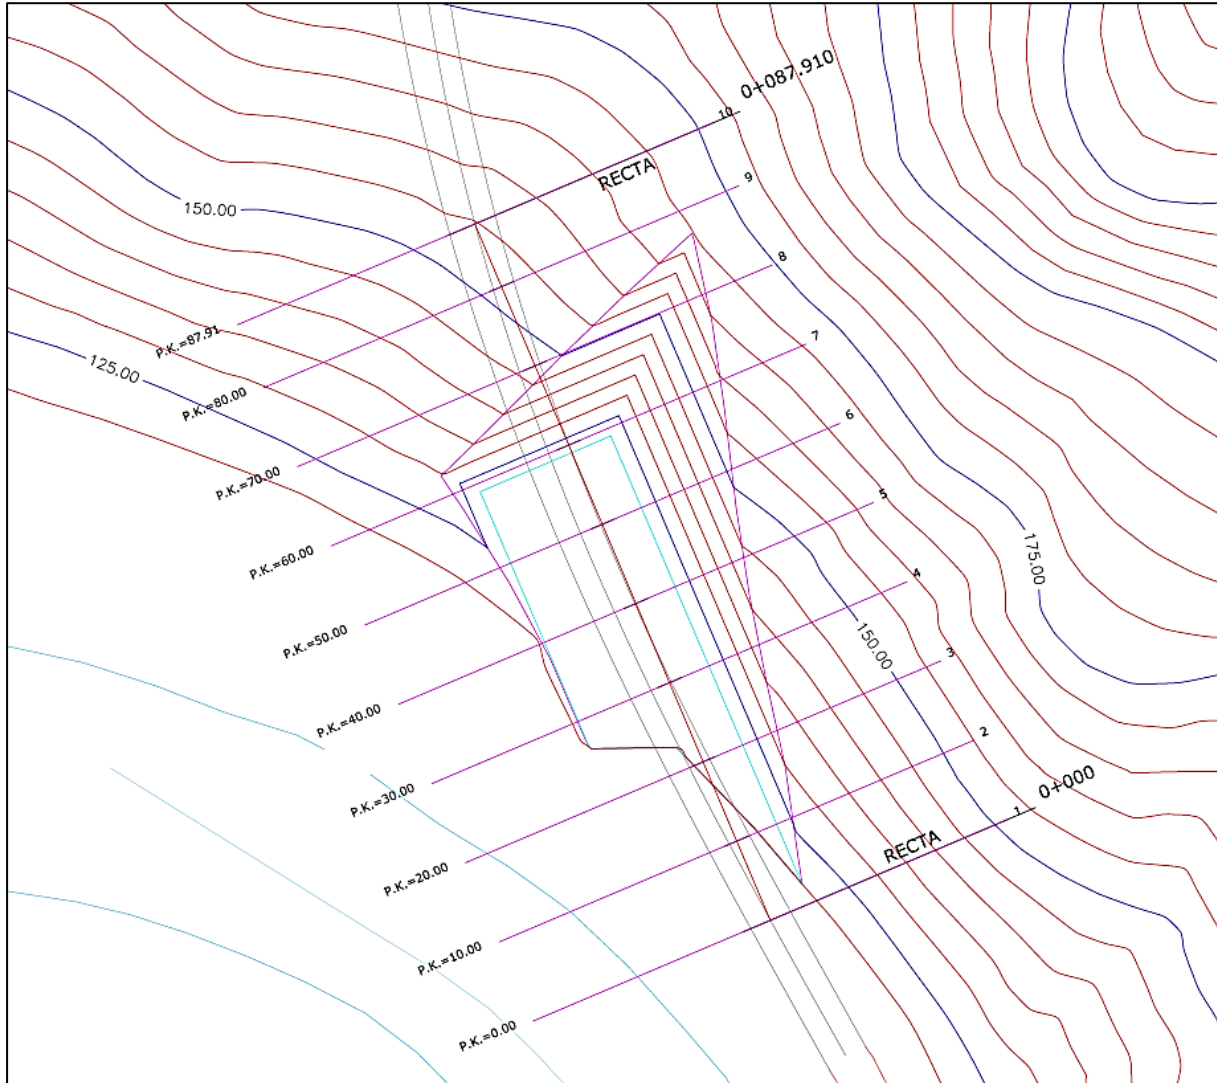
Perfiles de cubijaje del talud sur. Elaboración Propia
